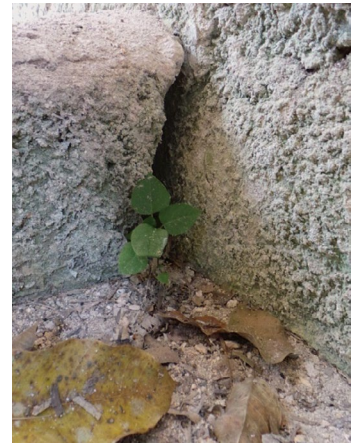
Acumulación de tierra, piedras de derrumbe y hojas secas de la cubierta sobre la banqueta del cuarto 6J2-11.
